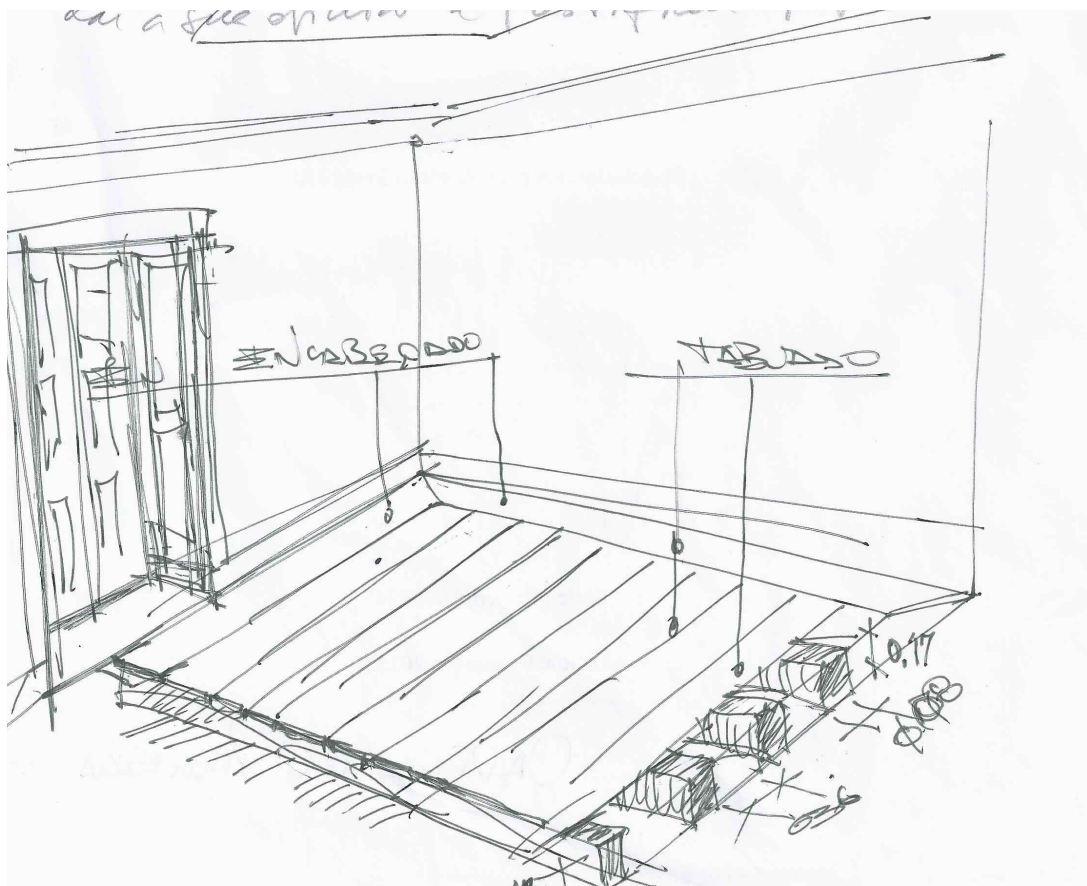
Levantamento *in situ* da estrutura de pavimento
